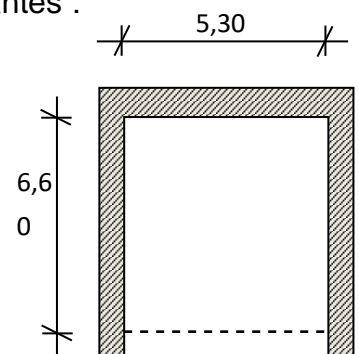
Dimensions du panneau de dalle le plus sollicité
